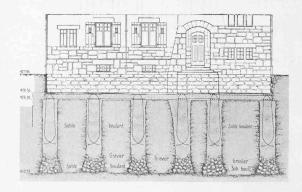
Elévation montrant la disposition des pylònes et leur liaison avec les poutres-semelles. — 1:250
